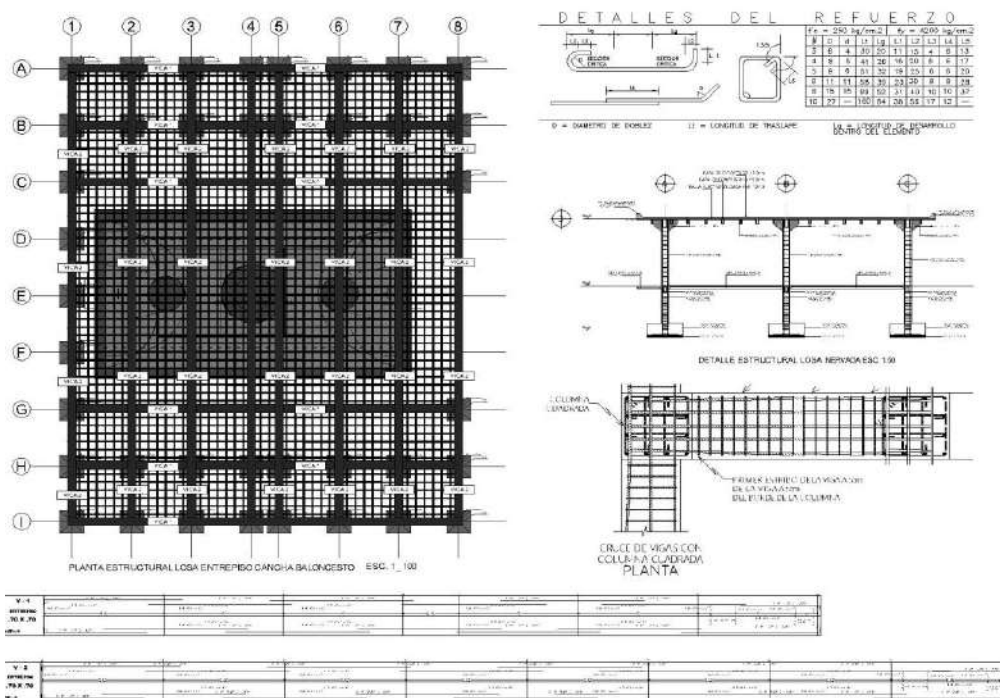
Detalles constructivos, losa de entrepiso cancha de baloncesto. Fuente: Elaboración propia 2021.
